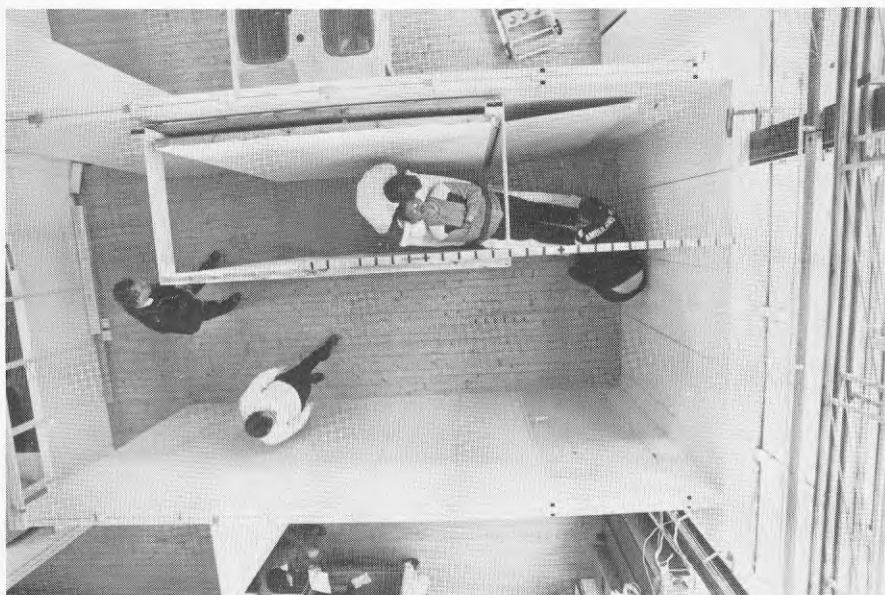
och 7. Utrymme 1300 mm. Uttransport av plan bår
